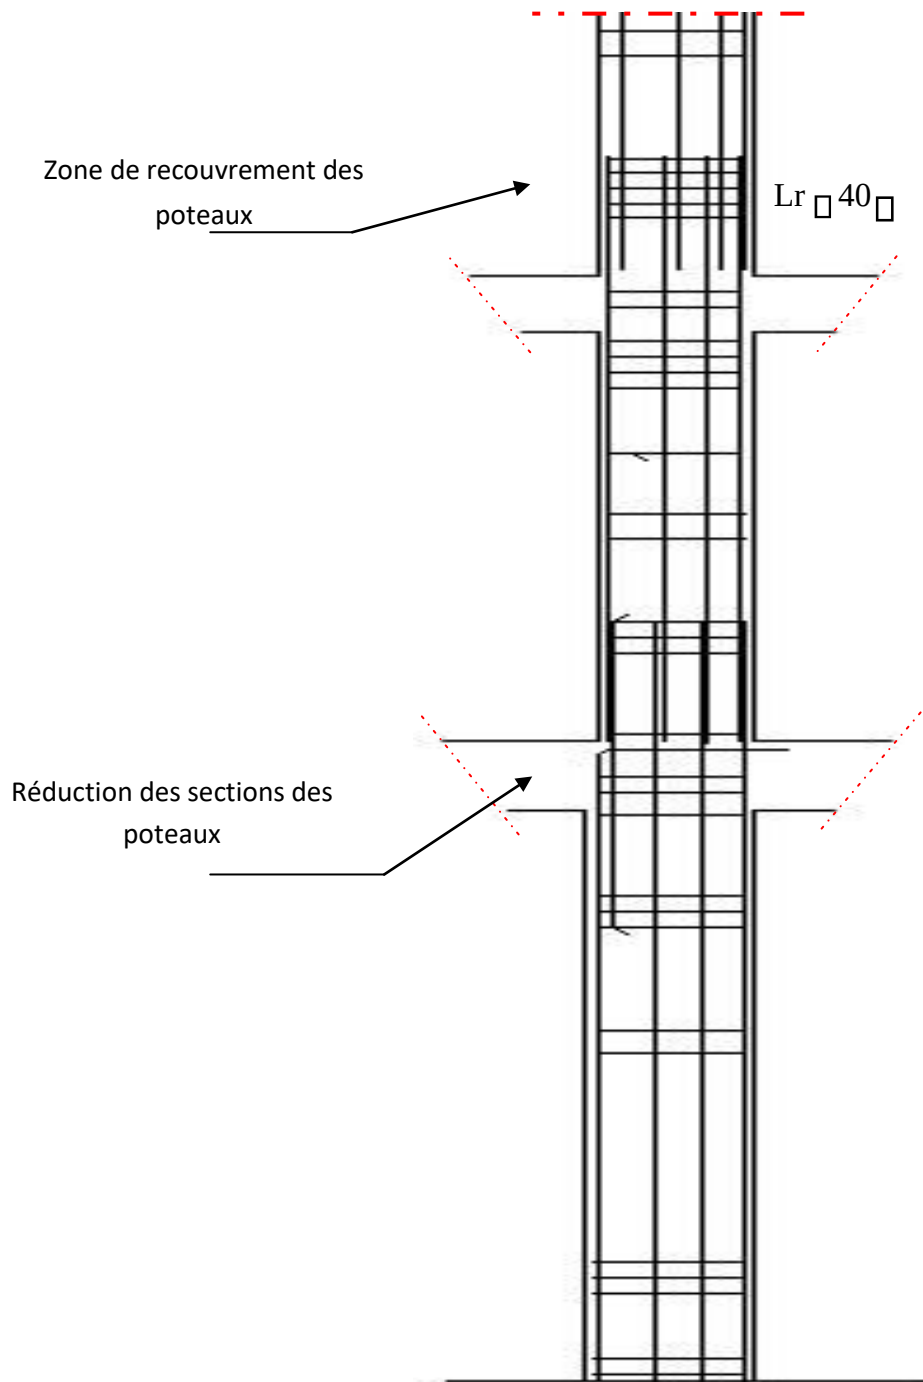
Disposition constructive des armatures des poteaux.
